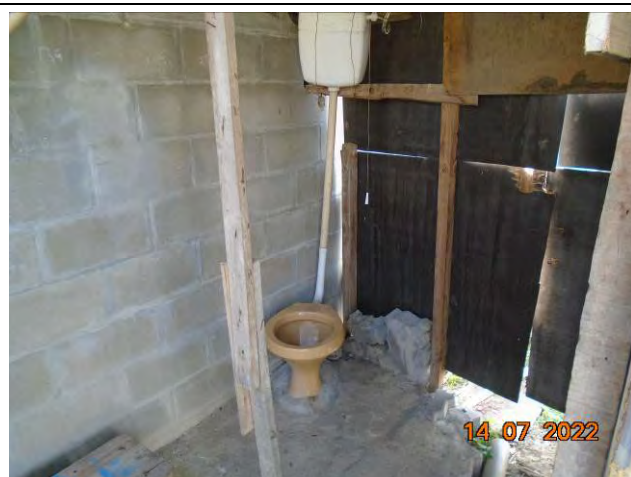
Detalhe do sanitário. Nota-se que o local possui instalações inadequadas para uso.
